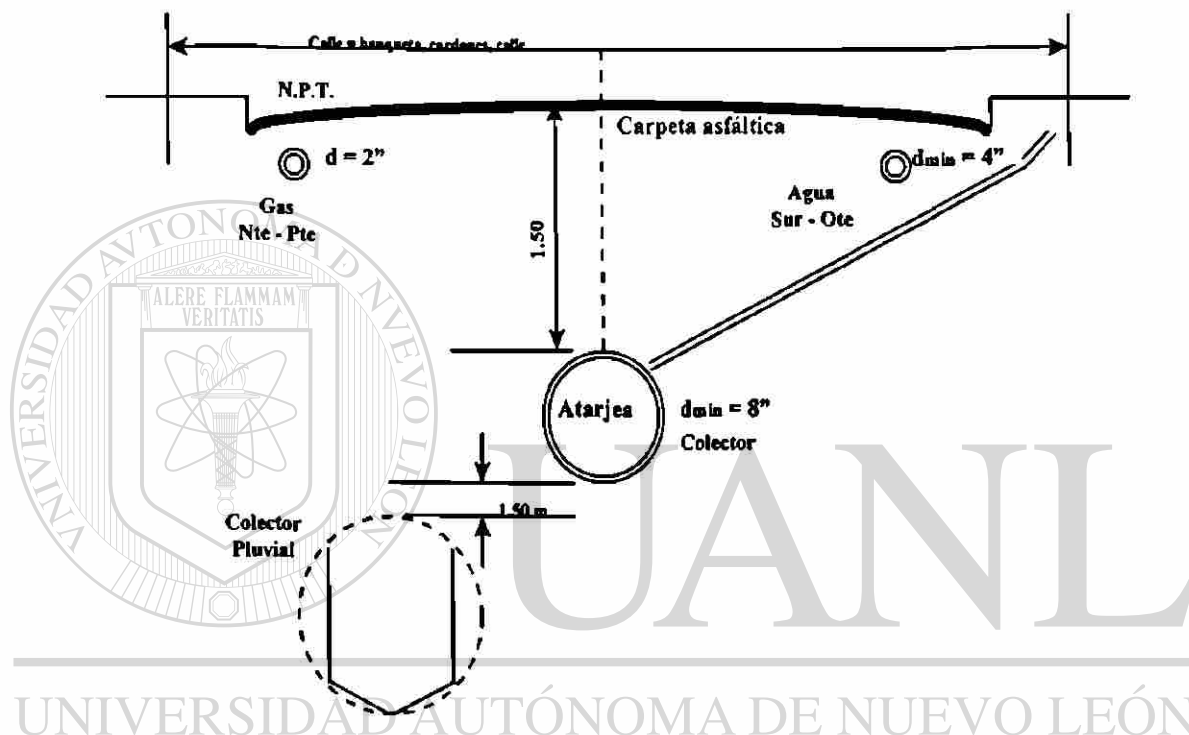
Corte típico de localización de una tubería de la red de alcantarillado
